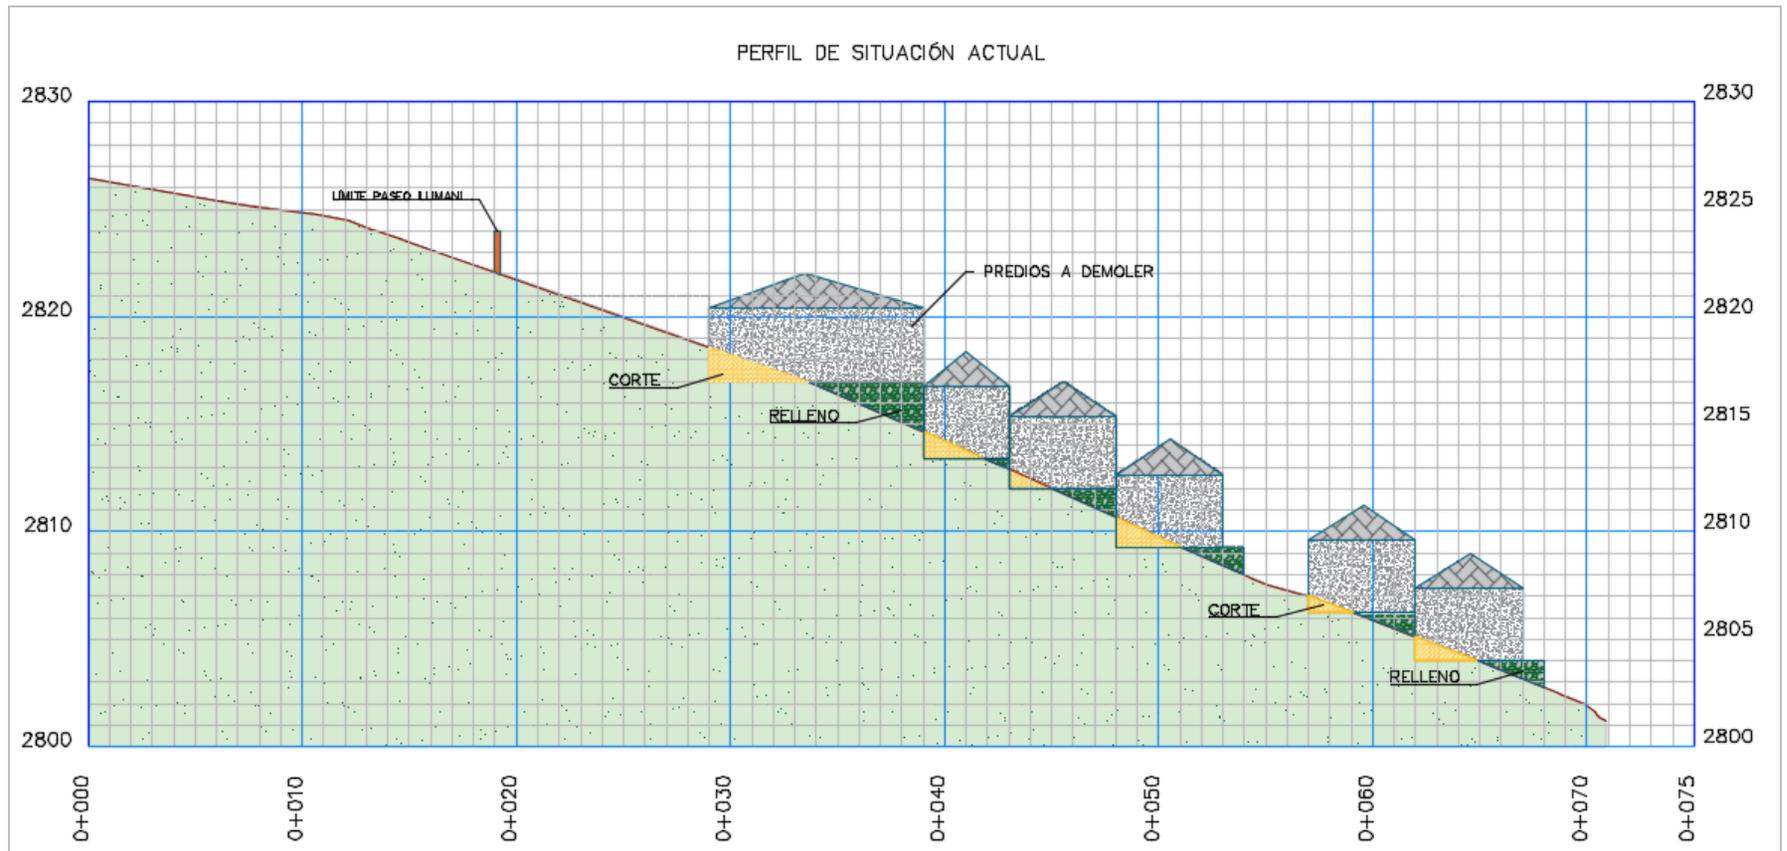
Perfil de la situación actual (Anexo V8)
